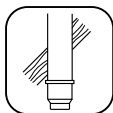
Montáž kotle a průchodu šikmou střechou
